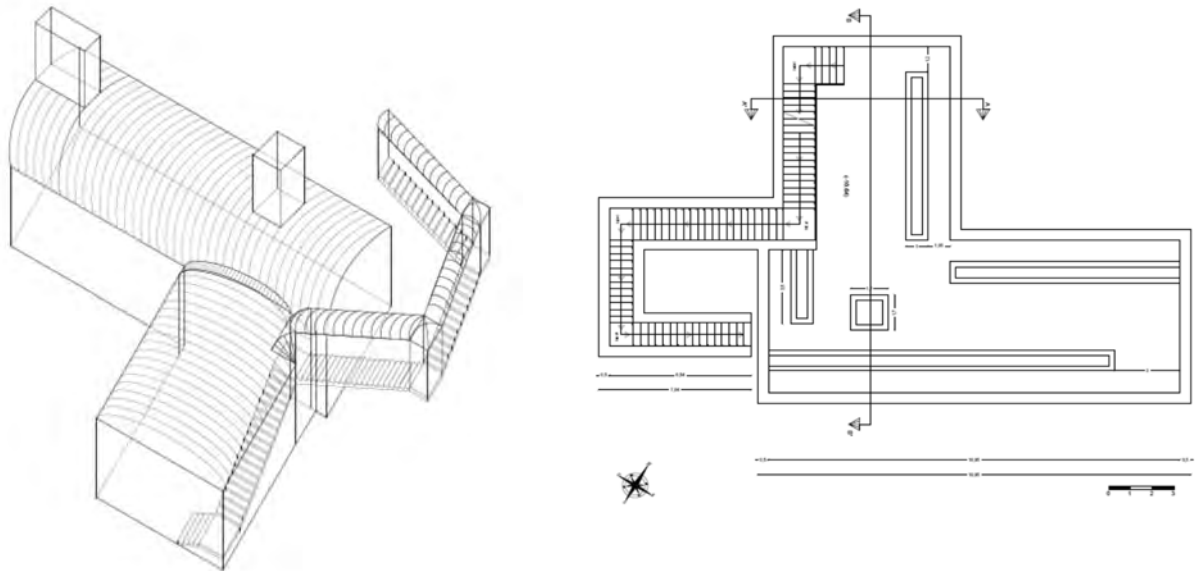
Schematizzazione assonometrica (sinistra) e pianta (destra) dell'ipogeo
